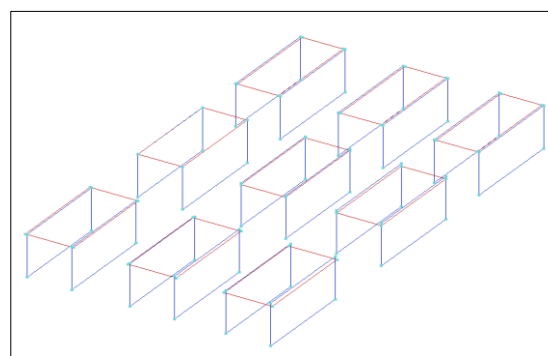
Экспортированные элементы соединения плит перекрытий и стен в SCAD++
